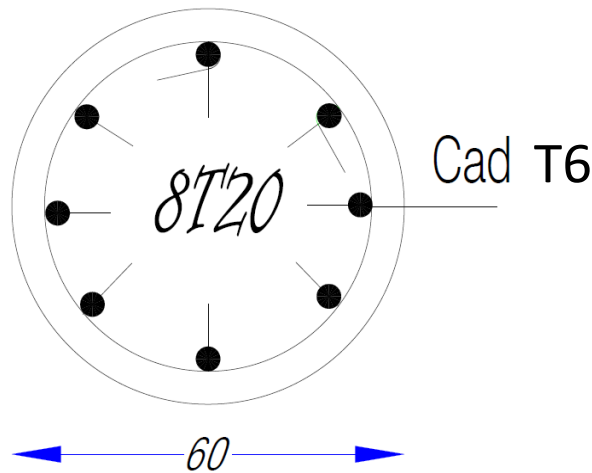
ferrailage poteaux circulaire (60 cm)
